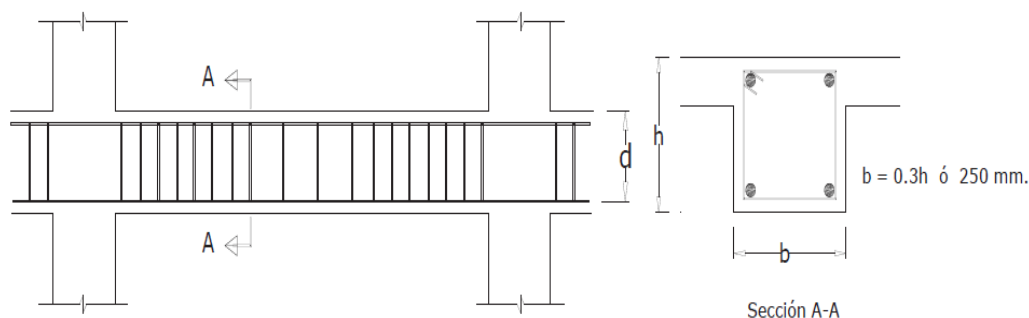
Ancho mínimo para una viga. Fuente: [4]
